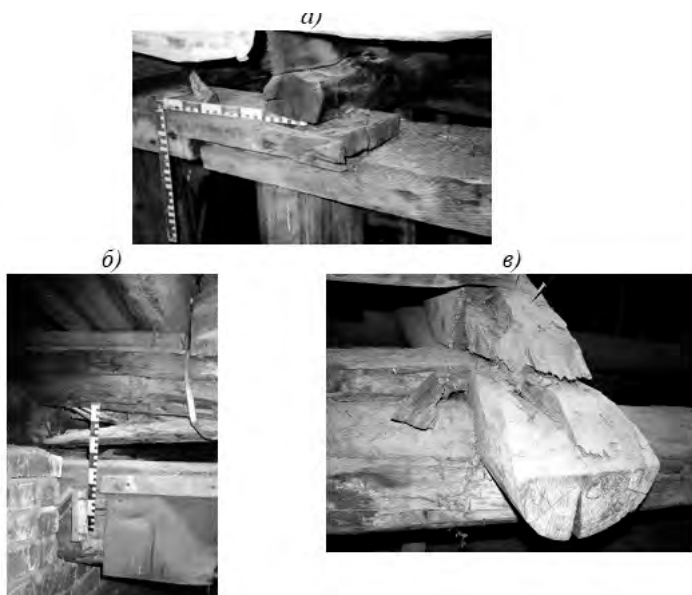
Разрушение узлов деревянных конструкций покрытий ОКН:
